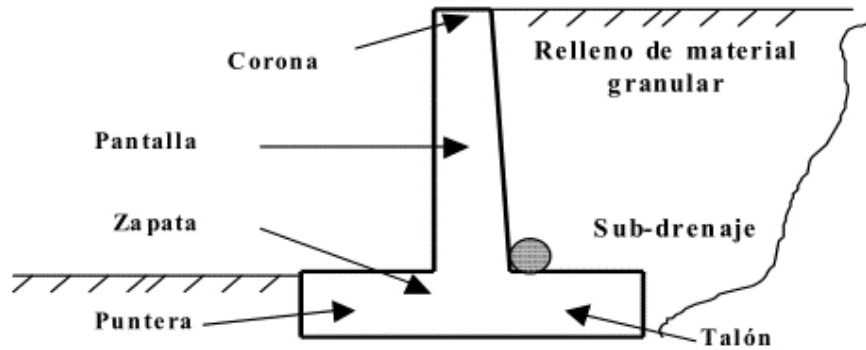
Tipo de Muro en Voladizo por Torres Belandria (2008)
